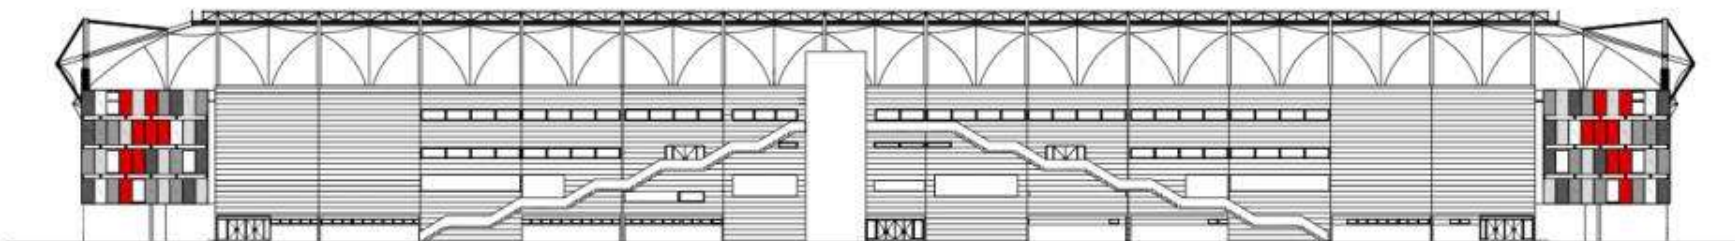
, PLANTA ARQUITECTONICA. www.archdaily.mx 19/10/2012
